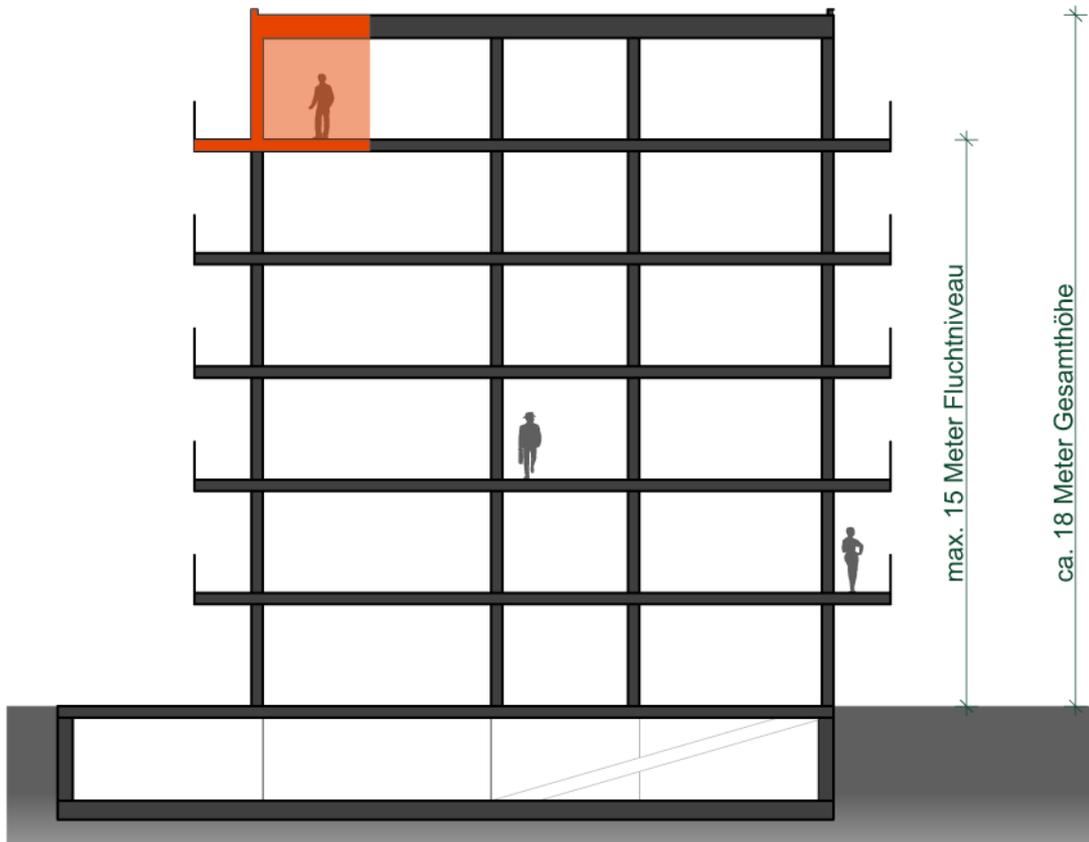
Schnitt: Bauteilausschnitt 1:200
